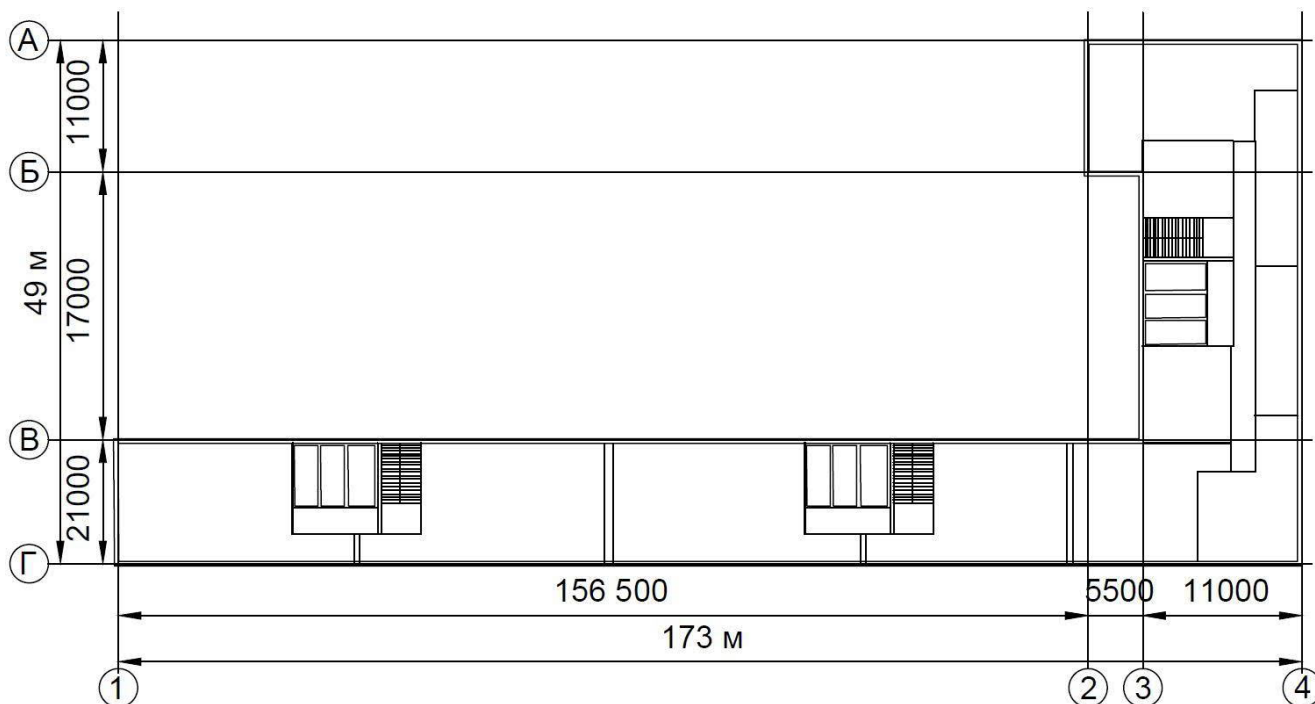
План подвального этажа зданий по адресам: г. Москва, Ленинский проспект, дом 74
